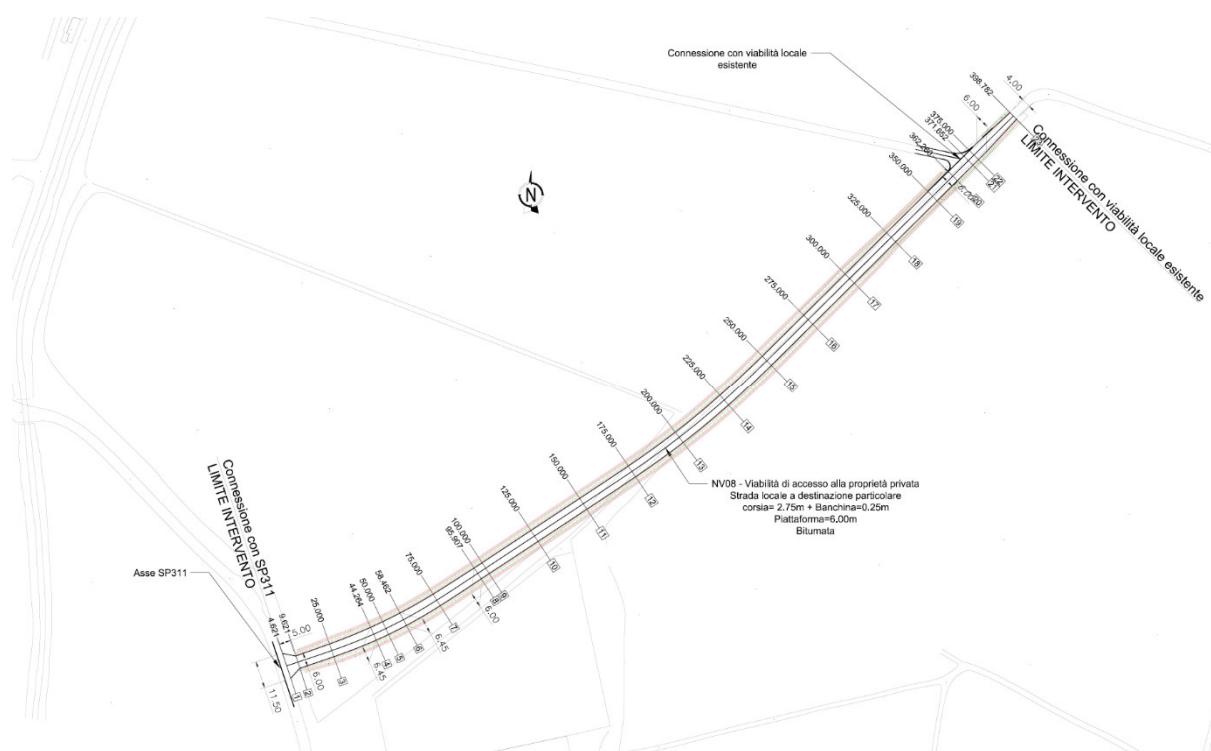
Stralcio planimetrico – NV08_Viabilità di accesso proprietà privata
